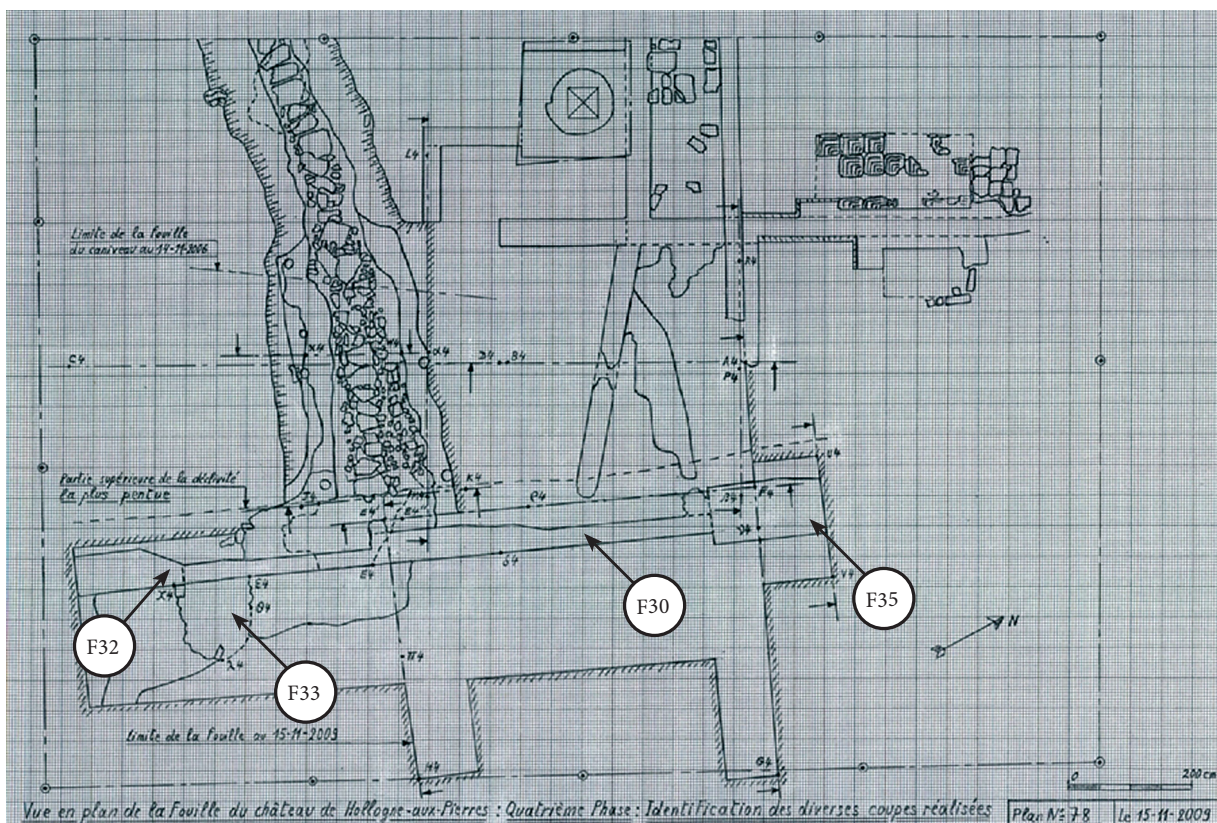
Plan du mur construit dans la dépression de terrain (plan de Claude Bourdouxhe).
